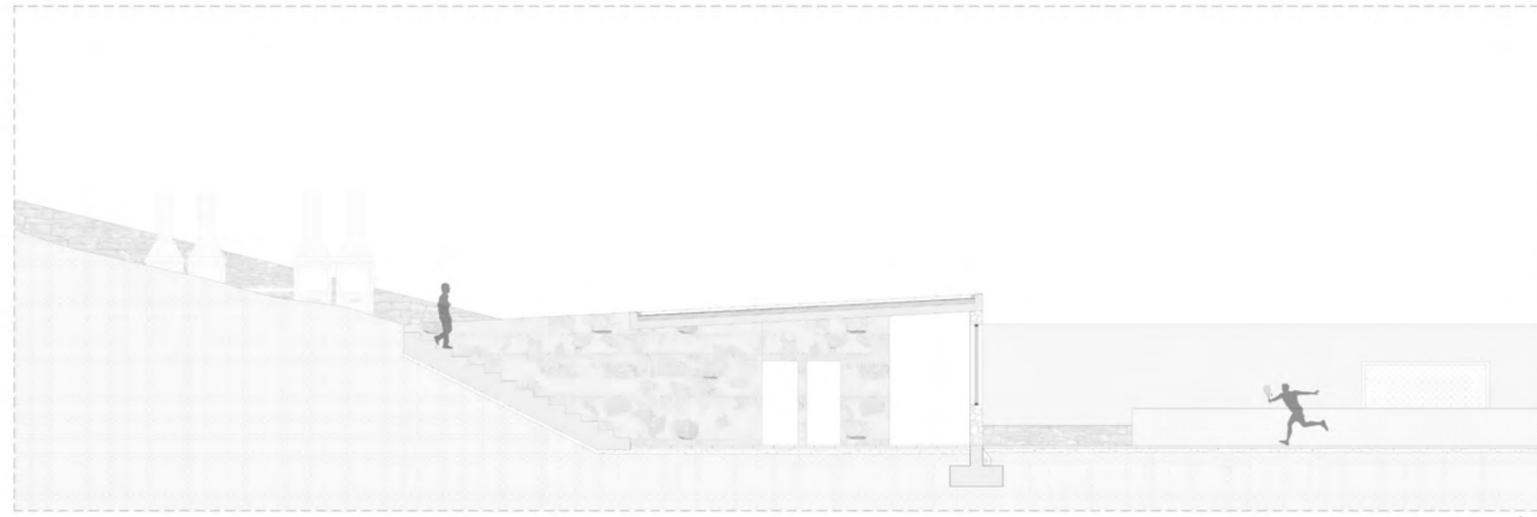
Planta e corte construtivo do edifício dedicado a balneários
